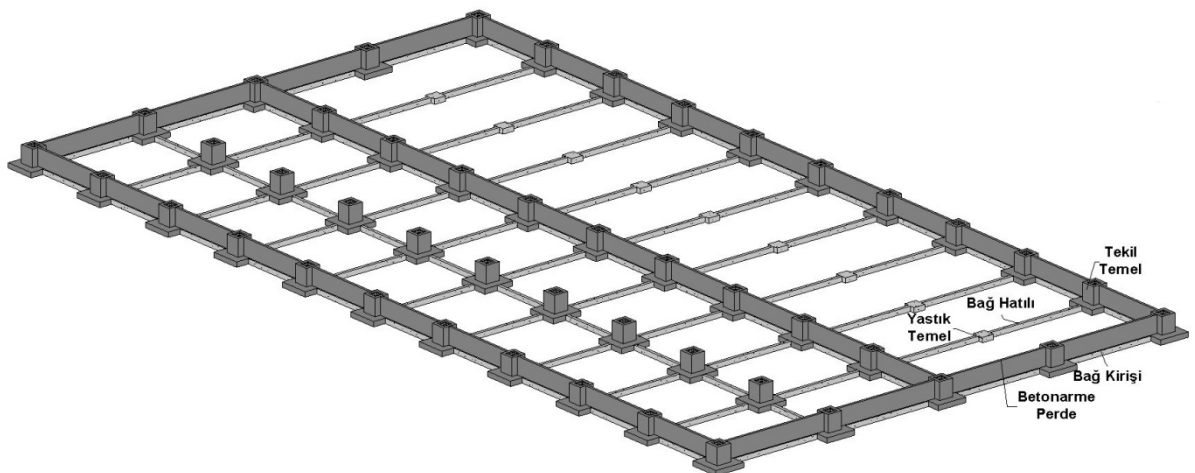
Betonarme taşıyıcı sistemi tamamlanmış prefabrike yapı örneği
